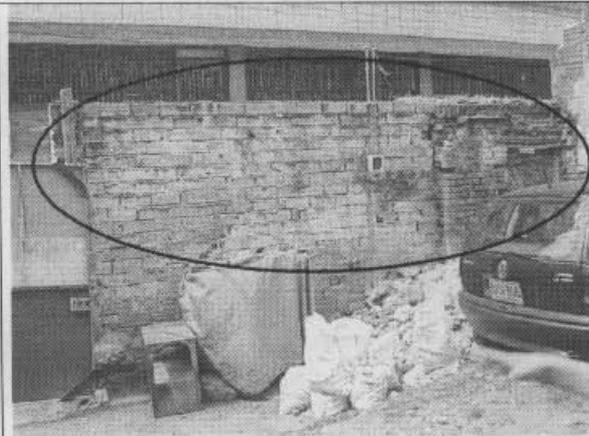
Detalle de muro suelto en fachada visto por el interior del inmueble, con mala calidad de construcción.
